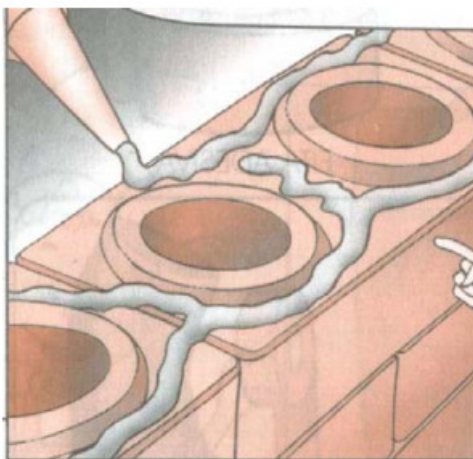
Detalhe da aplicação do filete de argamassa. Fonte: SAHARA (2009).
